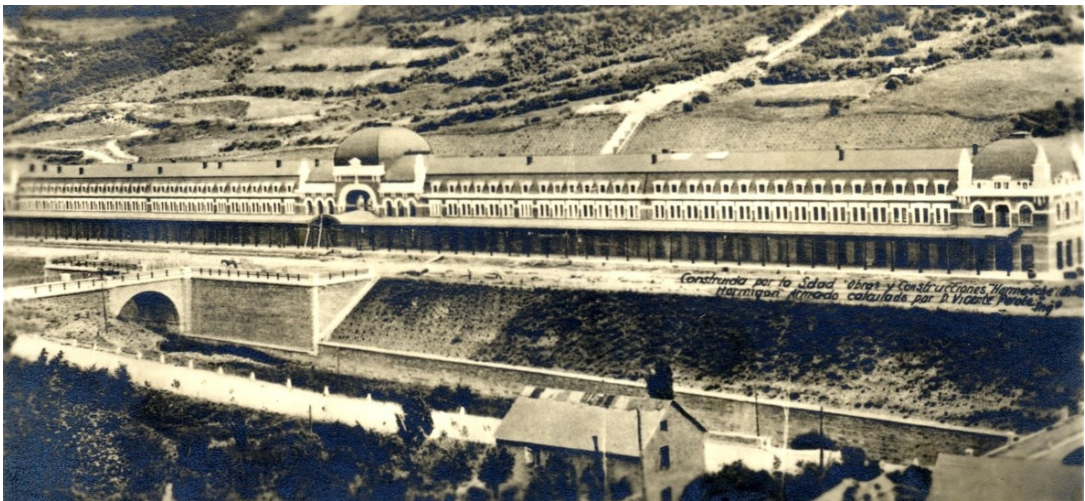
Fotografía de la estación casi acabada; en ella aparece una inscripción donde se puede leer «Construida por la Sdad Obras y Construcciones Hormaeche (...) Hormigón armado calculado por D. Vicente Perote Ingeniero». Fotógrafo desconocido, col. José Coarasa.
